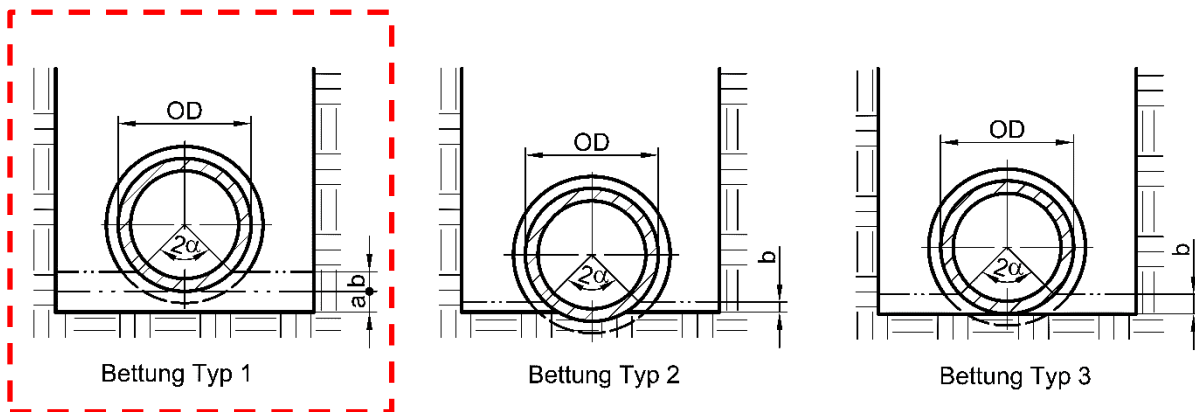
Prinzipskizze der Bettungstypen nach DIN 1610 (siehe Norm für das Kanalnetz, Berliner Wasserbetriebe, Regelblatt 15, Bild 2). Rot umrandet: durchzuführende Bettung im Untersuchungsgebiet.
